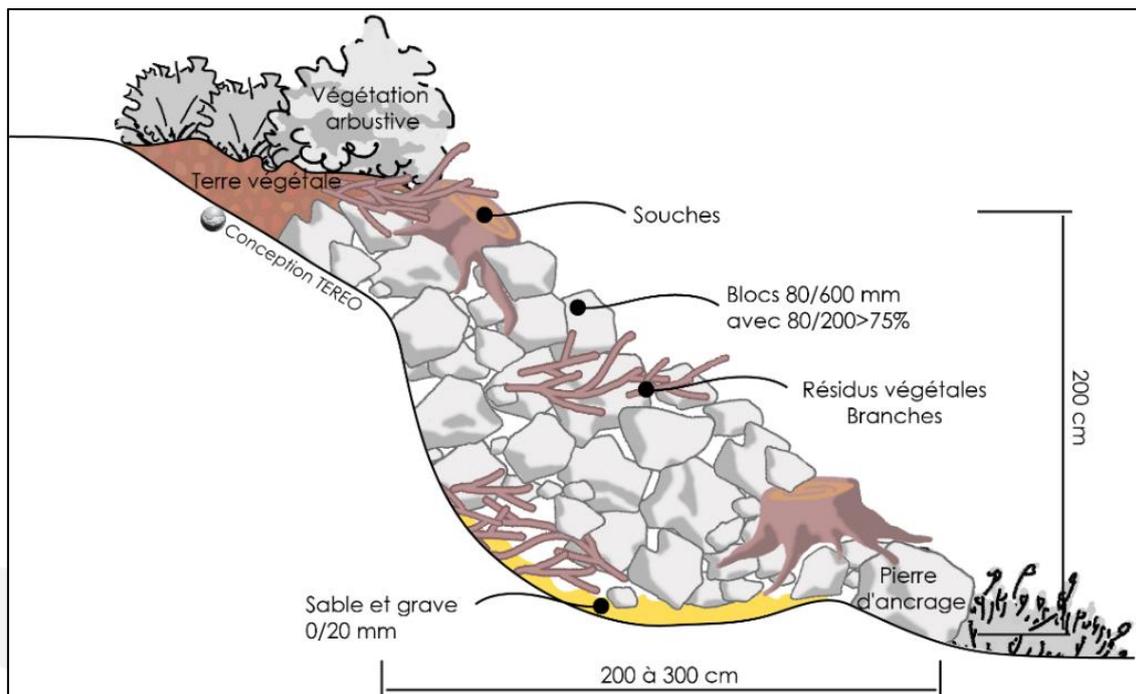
Coupe de principe d'un hibernaculum sur pente
